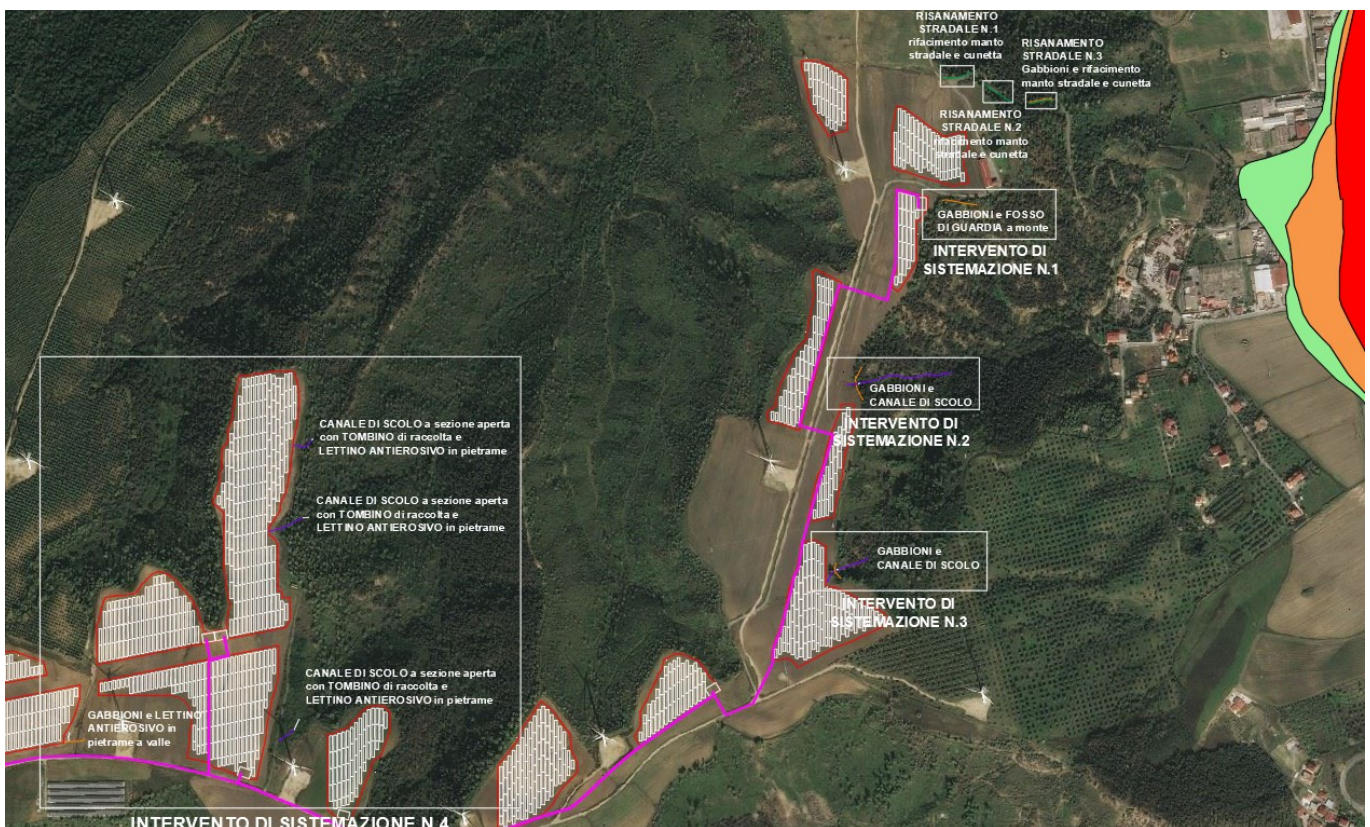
Distanza delle opere di mitigazione dalle aree del Piano Stralcio PAI – Rischio idraulico
